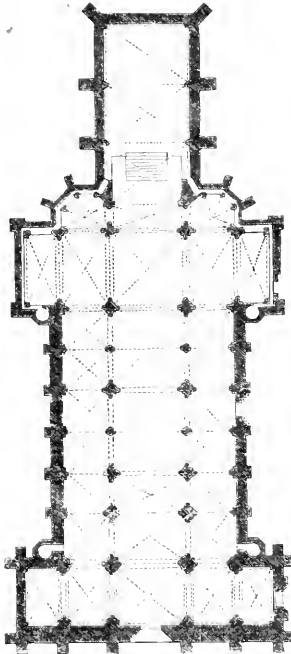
Grundriß des Münſters zu Schlettſtadt.
